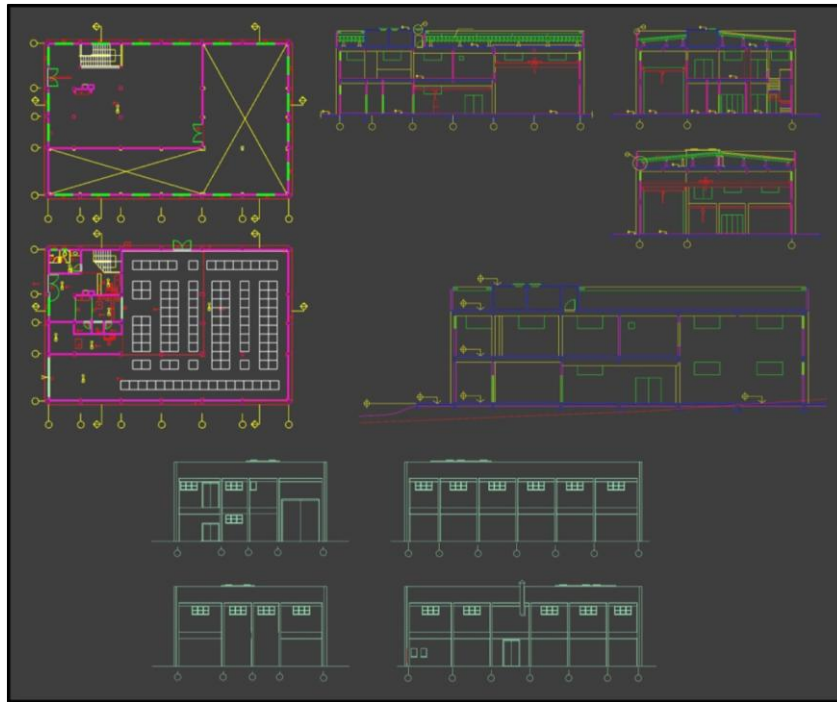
Planta baixa utilizada na construção do depósito de rejeitos do IEN
